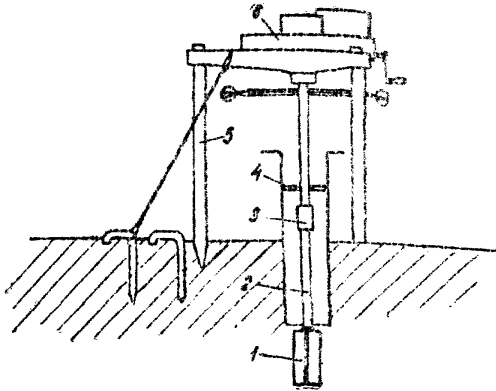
Лопастной прибор конструкции ЦНИИС: 1—лопасть; 2—штанга; 3—соединительная муфта; 4—центрирующая муфта; 5—стойка прибора; 6—головка
